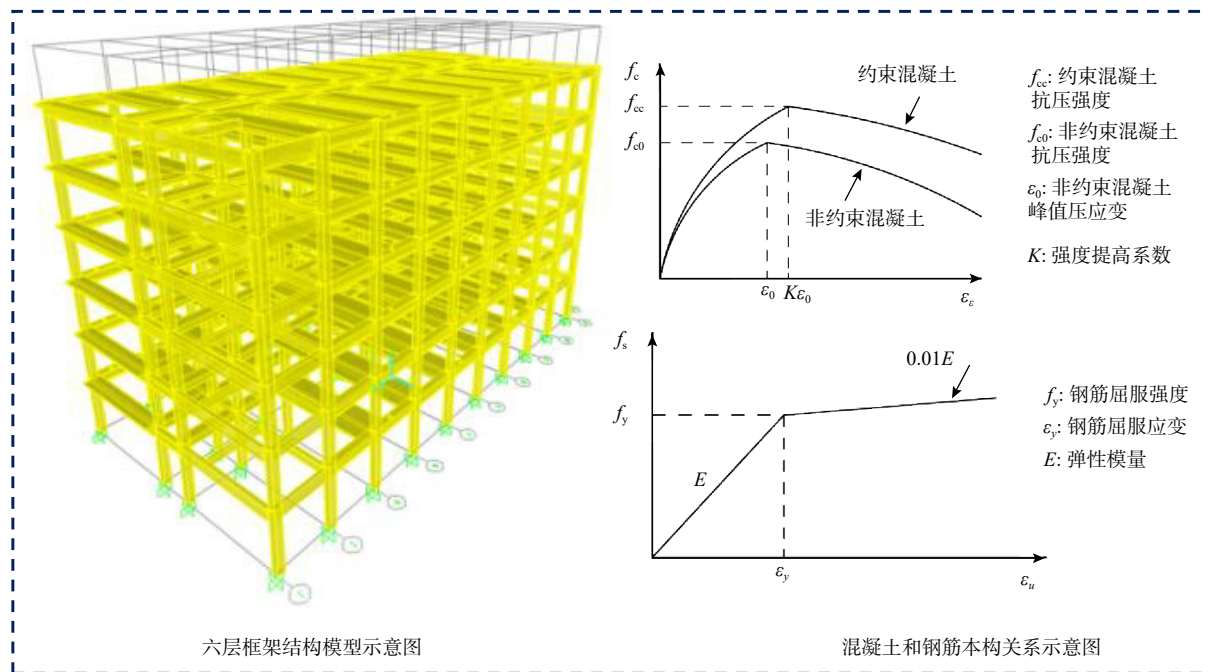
6 层框架结构以及混凝土和钢筋本构关系示意图
